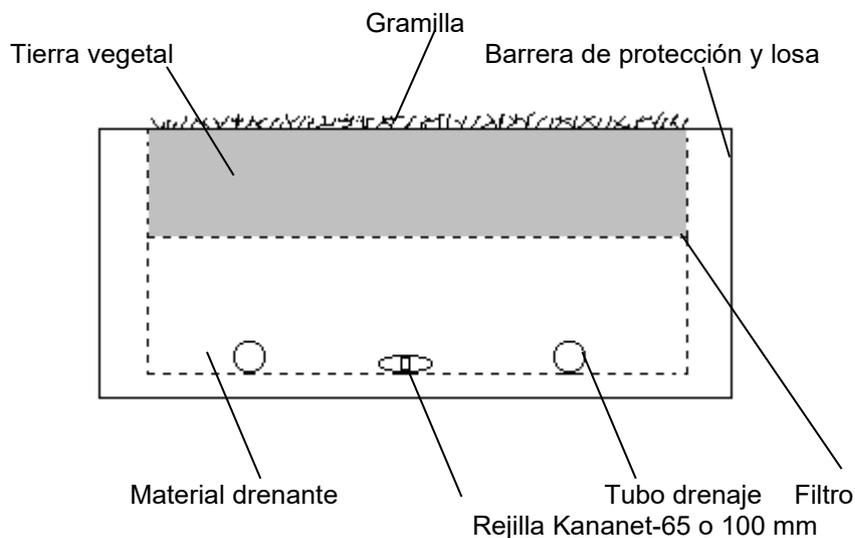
Sección esquemática de colchón drenante sobre losa, la colocación de los tubos de drenaje Kananet permite una captación más rápida de las aguas, disminución en la altura necesaria del colchón drenante y mayor espaciado entre rejillas.
